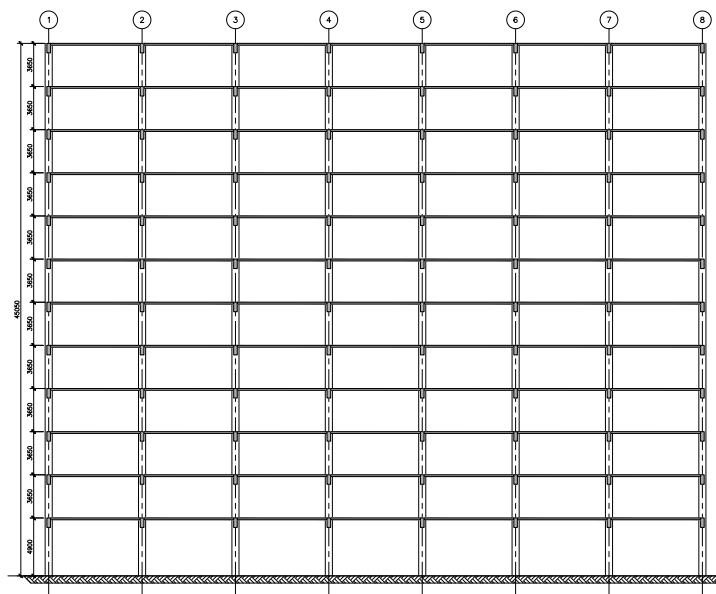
Edifício Padrão - Seção longitudinal (dimensões em milímetros)
